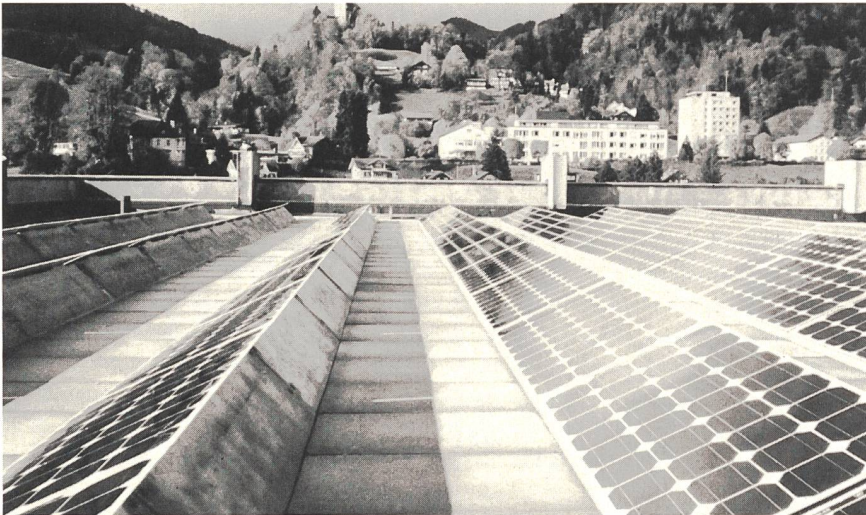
Solare Pilotanlage mit Betonsockeln als Tragkonstruktion (Solarmodule auf dem Dach der Gewerblichen Berufsschule Wattwil SG).
